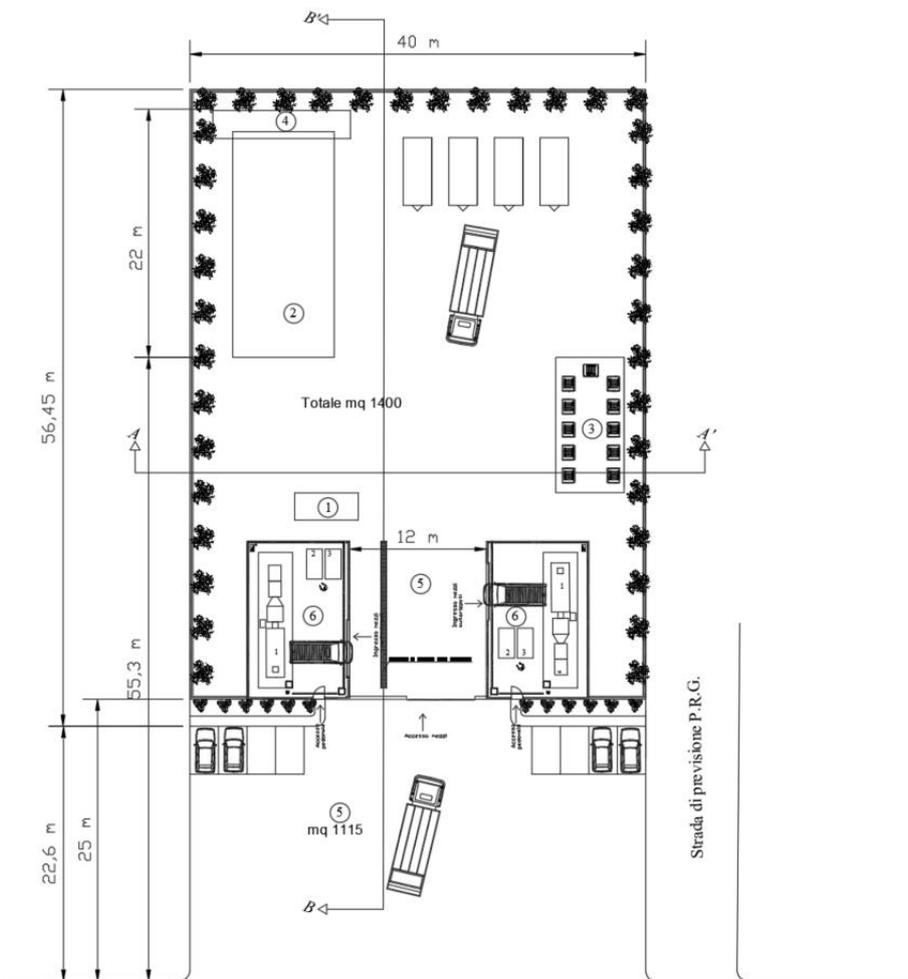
Planimetria del Centro Comunale di Raccolta in progetto.
